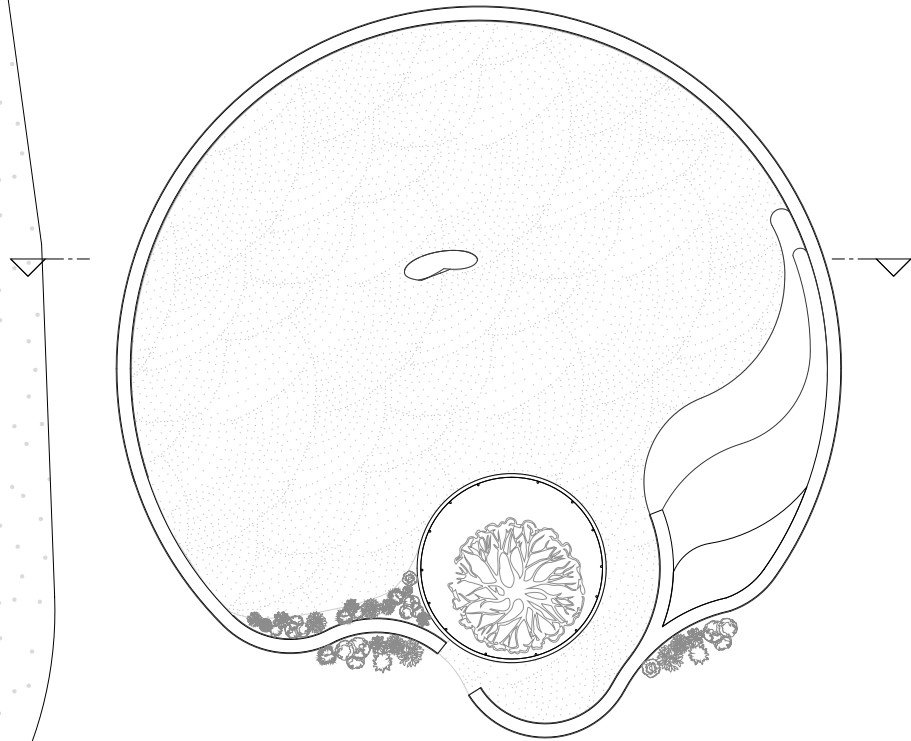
Grundriss des Nymphaeum (eigene Darstellung)
